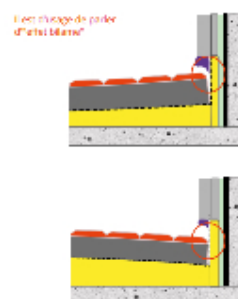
et schéma illustrant la fissuration due au retrait excessif de la chape ou du mortier surmontant un isolant
